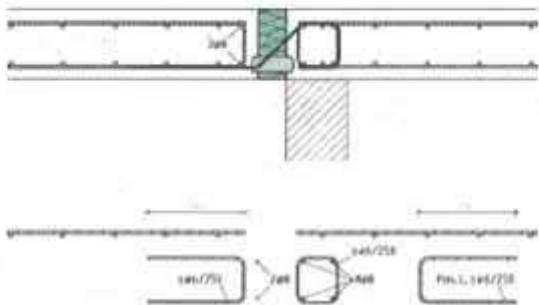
Bewehrungsführung Q bei direkter Lagerung und deckenseitig geschlauften Querkraftstäben
